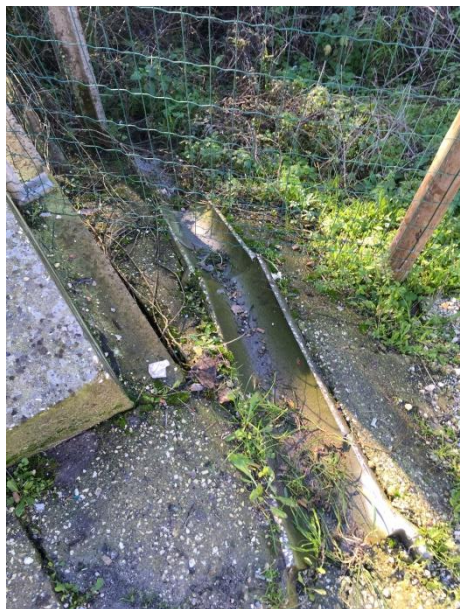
Conduta em meia cana de condução de águas pluviais entre a parte norte da instalação e a área impermeabilizada lateral do pavilhão 2
